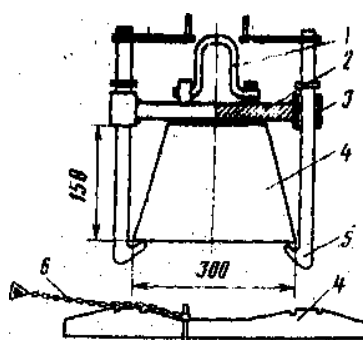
Захват для вытаскивания железобетонных шпал:
